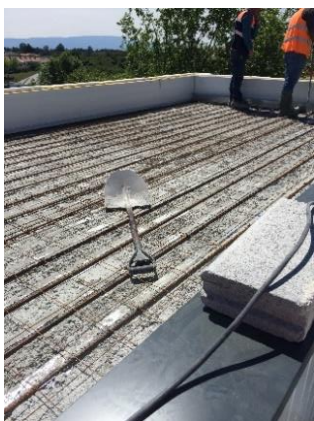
Pormenor de uma laje com chapa colaborante
